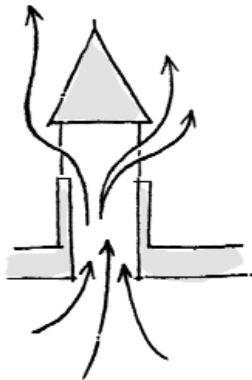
bis. El efecto chimenea favorece la ventilación vertical
